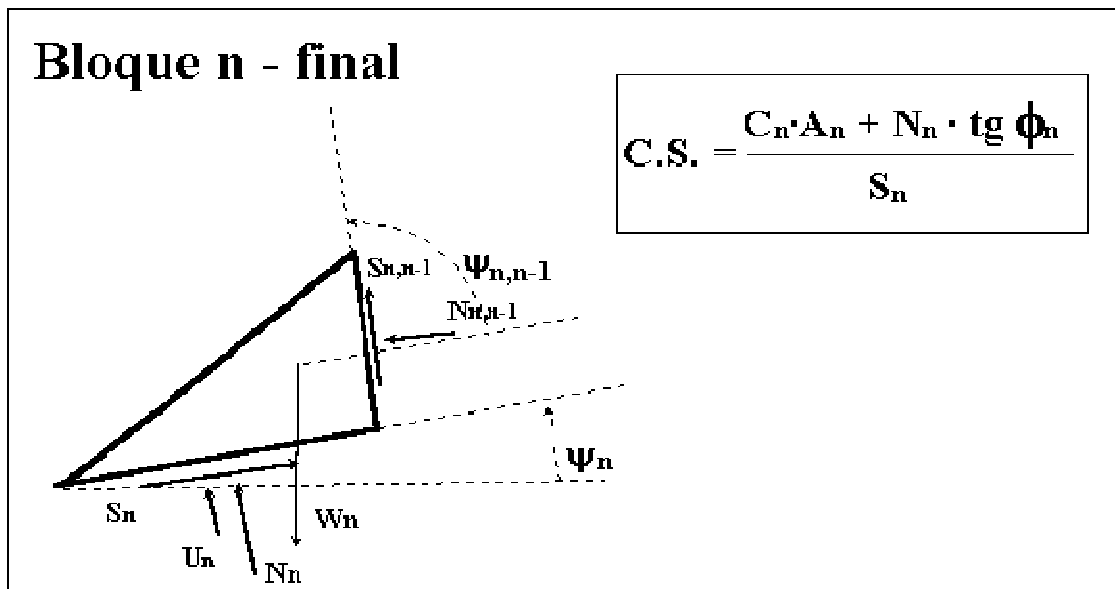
Geometría y fuerzas aplicadas al bloque final donde se calcula el CS.
